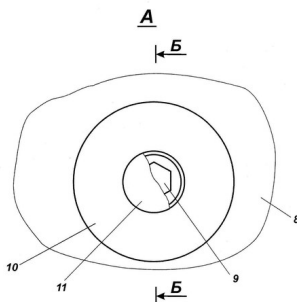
Вид А на рис. 1, крепление плитного утеплителя к монтажным полосам [4], где: 8 – ветрозащитный слой; 9 – саморезы; 10 – дистанцер; 11 – заглушка.
